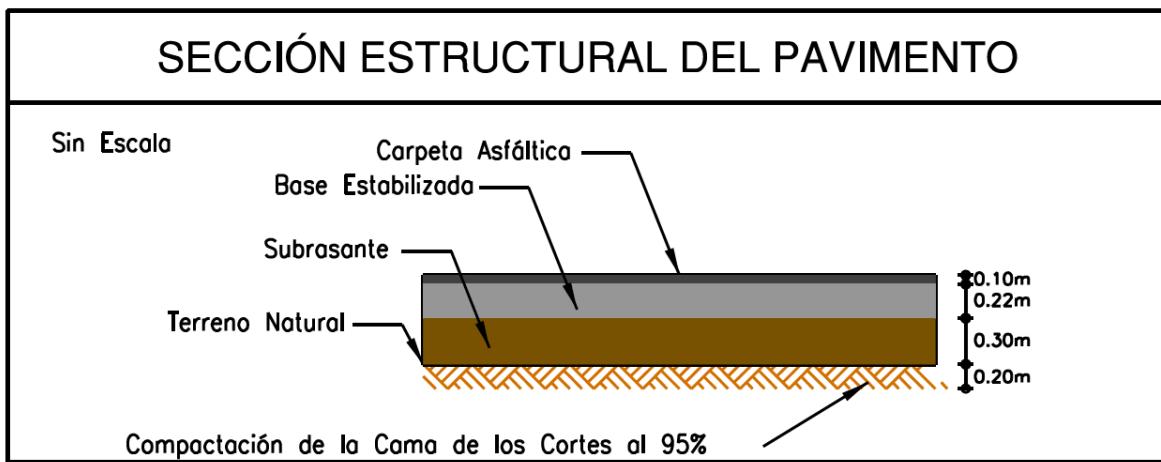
Sección Estructural del Pavimento definitiva⁶.
